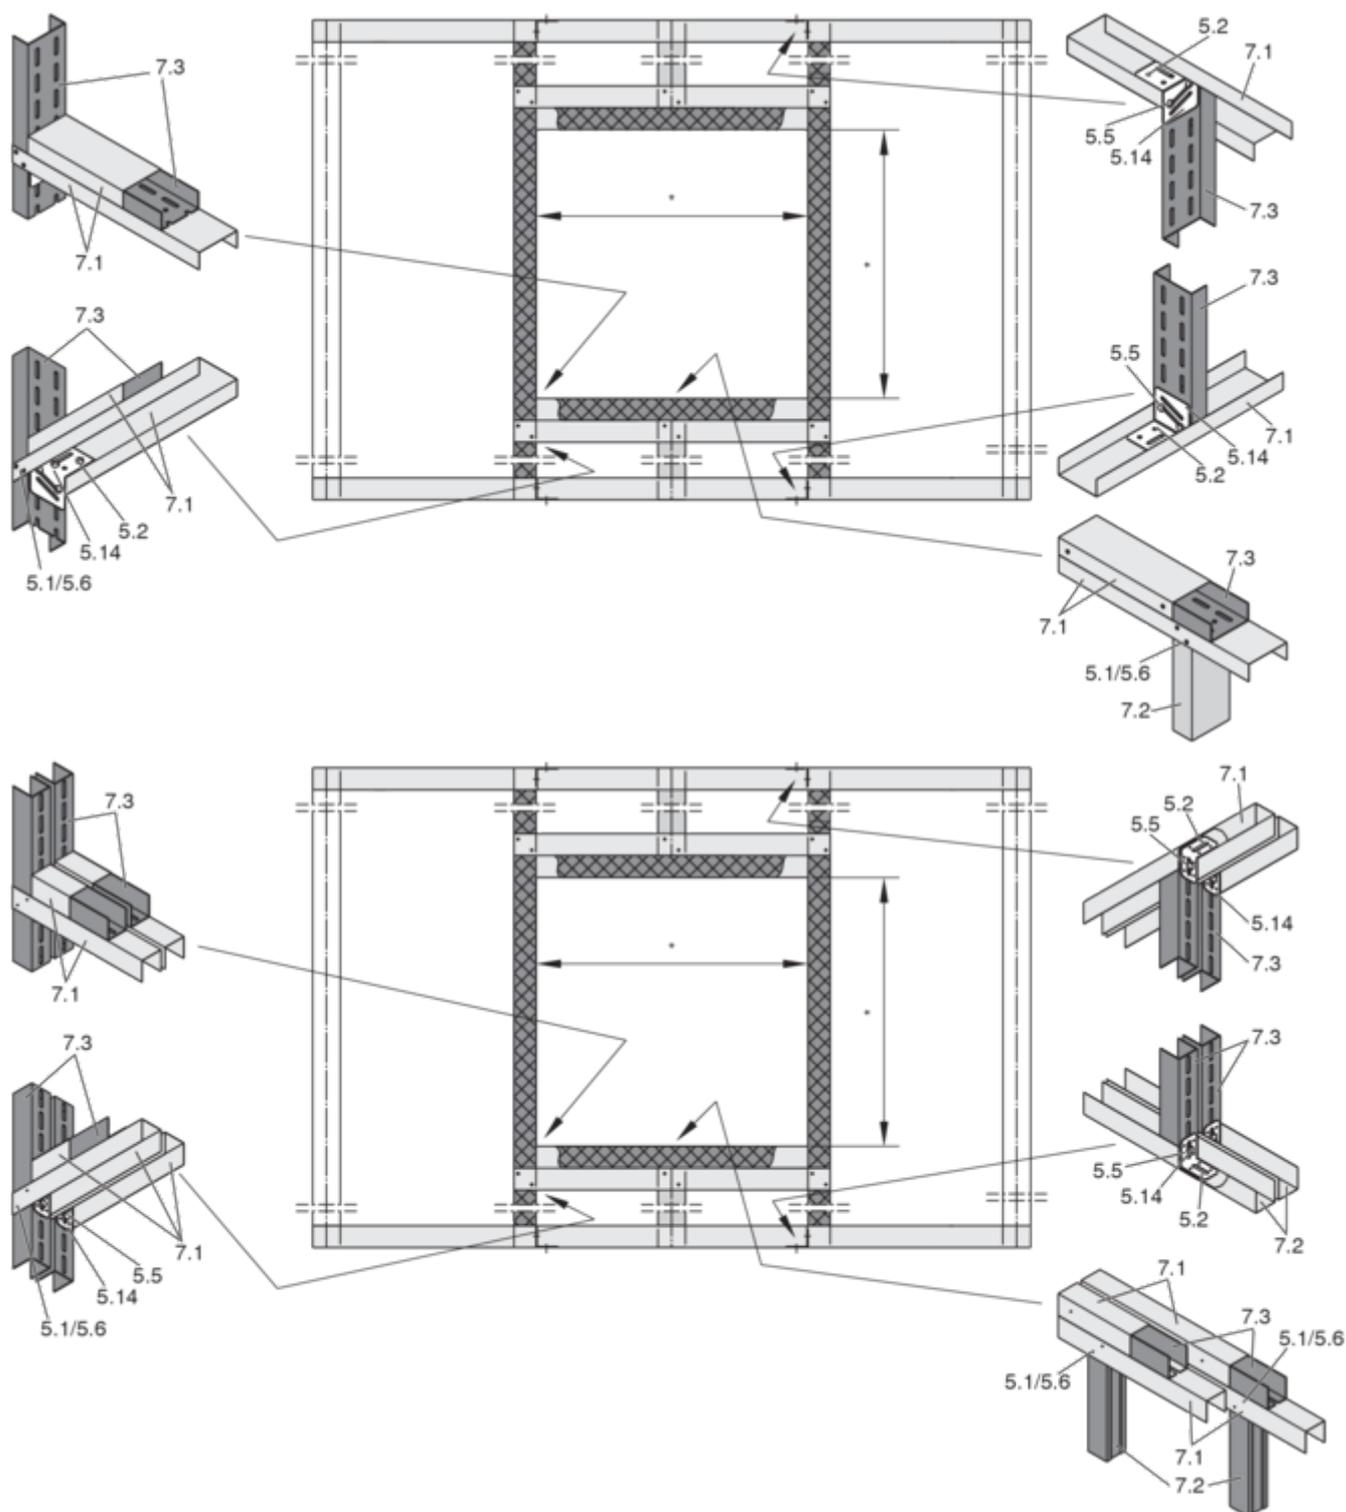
Metallständerwerk Brandwand, einfache und doppelte Ausführung
